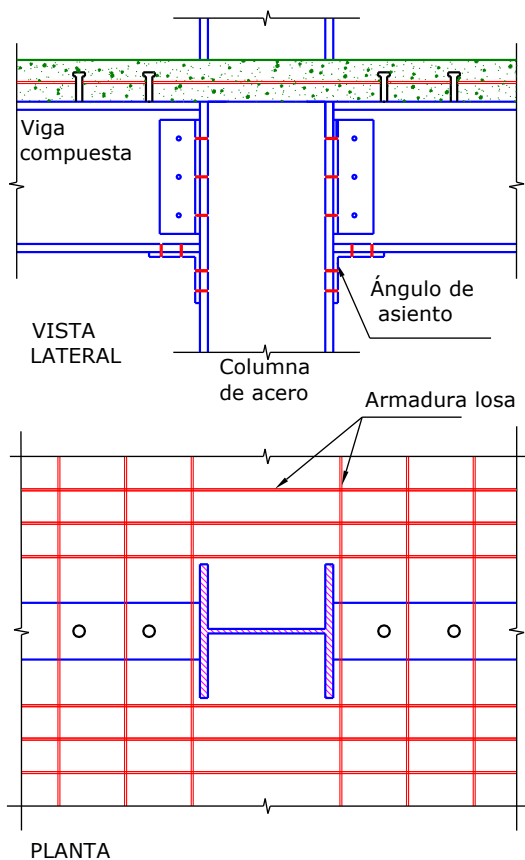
Conexión parcialmente restringida entre una columna de acero estructural y una viga compuesta.
